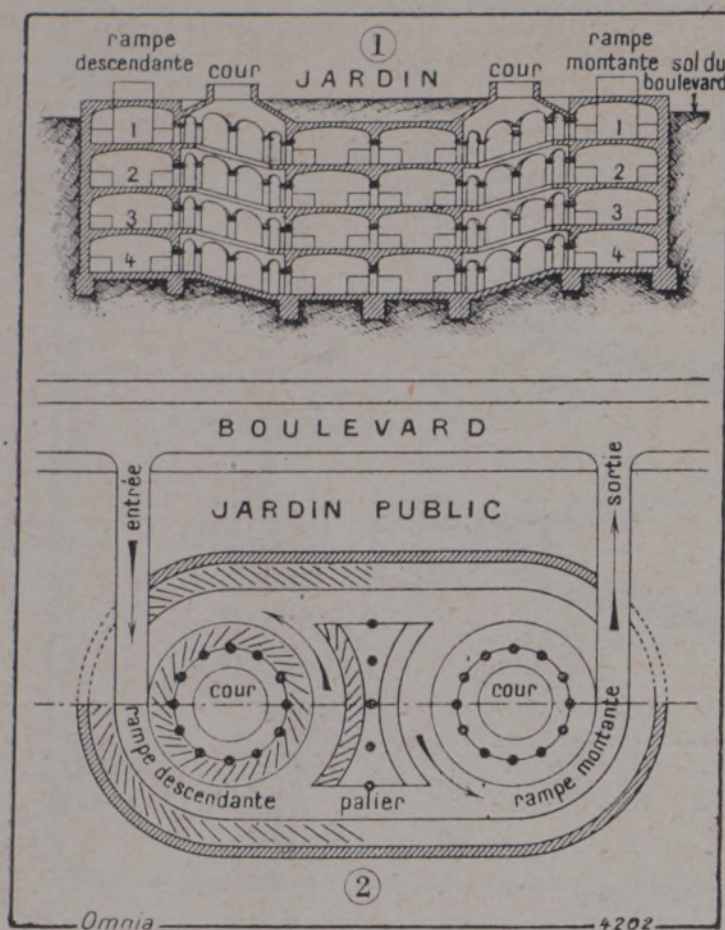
Fig. IV. — PLAN D'UN GARAGE SOUTERRAIN PRÉVU SOUS UN ESPACE LIBRE, UN JARDIN PUBLIC PAR EXEMPLE. A PROXIMITÉ D'UNE GRANDE ARTÈRE. — 1. Coupe transversale. — Ce garage comporte 4 sous-sols desservis par 2 rampes hélicoïdales (une pour la montée, l'autre pour la descente des voitures). Il est éclairé et ventilé par 2 cours circulaires dont les orifices débouchent dans le jardin public. — 2. Plan du premier sous-sol — Ce projet est dû à M. Bourdeix.
